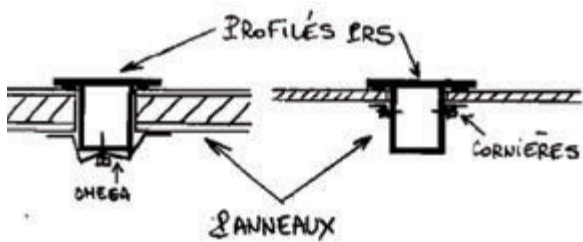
poteaux permettant la pose et la dépose des panneaux selon un mouvement horizontal
